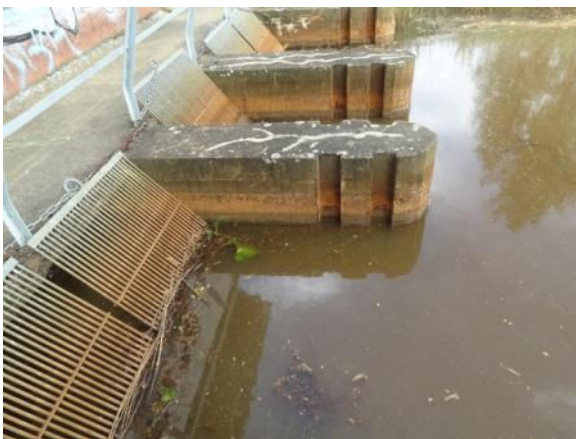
Ständergraben: Einlauf Schöpfwerk vor Mündung
